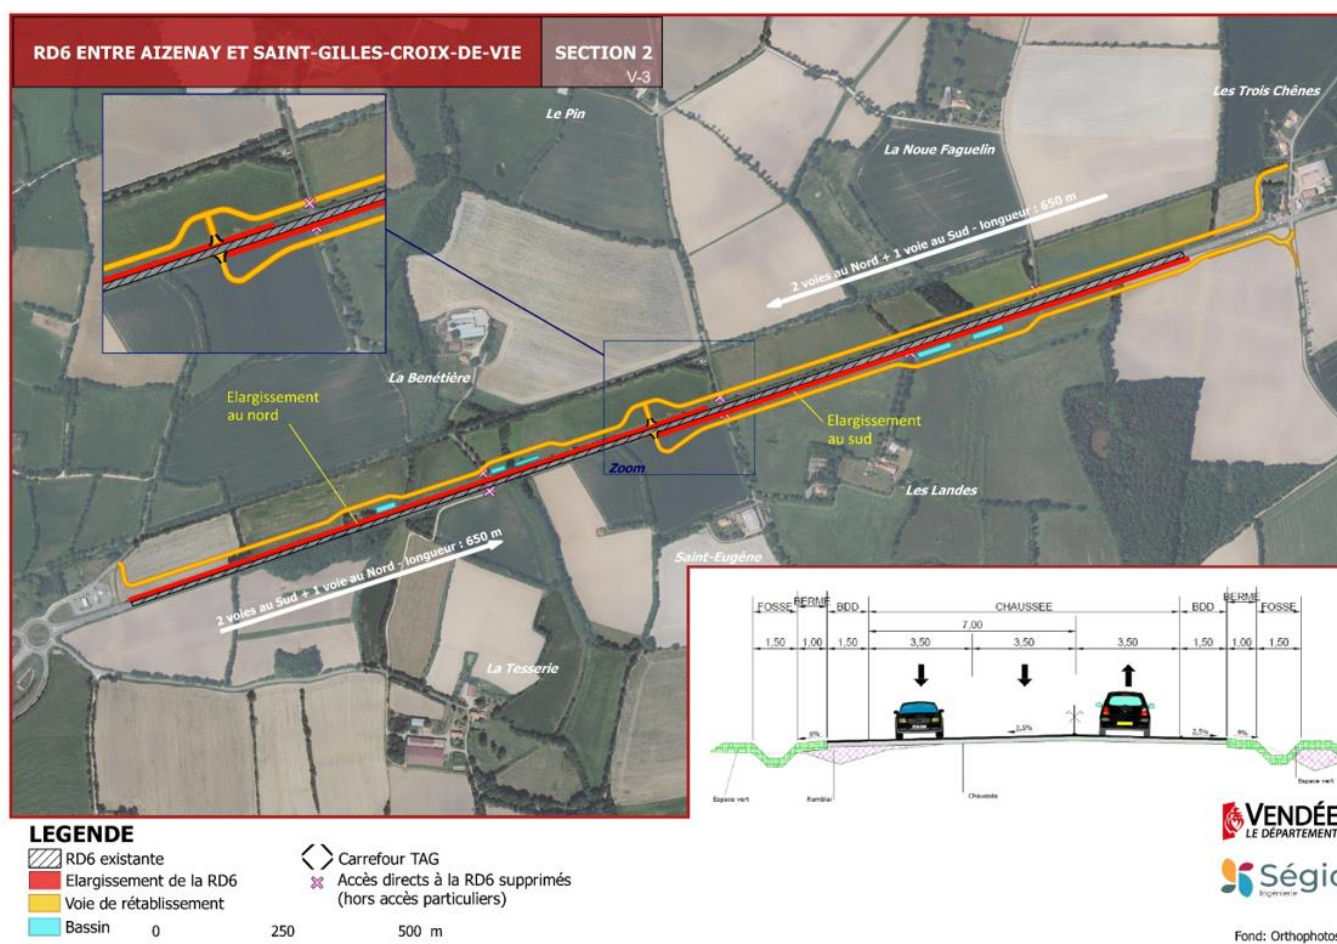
Plan de la section 2 retenue à l'issue de la concertation
